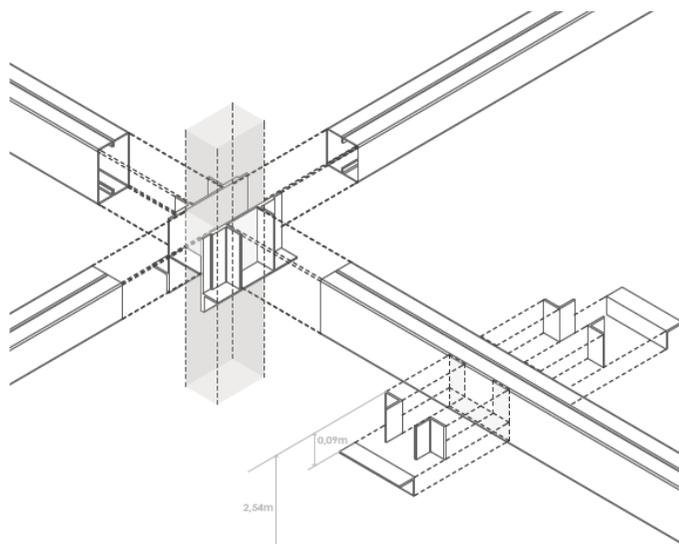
Esquema tridimensional de la unión a cortante de la estructura de acero conformada al frío, entre columnas y vigas principales con vigas secundarias.
